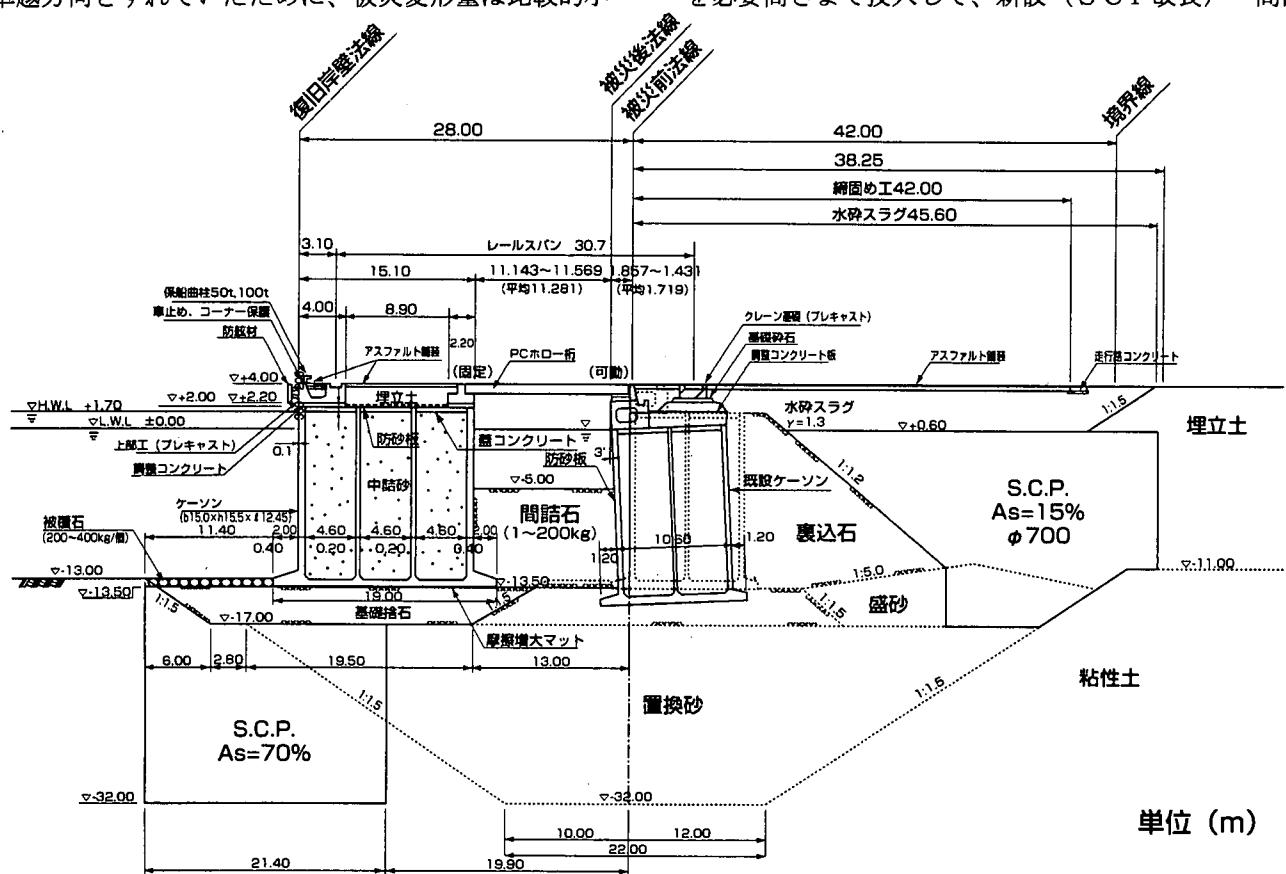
六甲アイランド -13m岸壁RC2 の標準断面図
